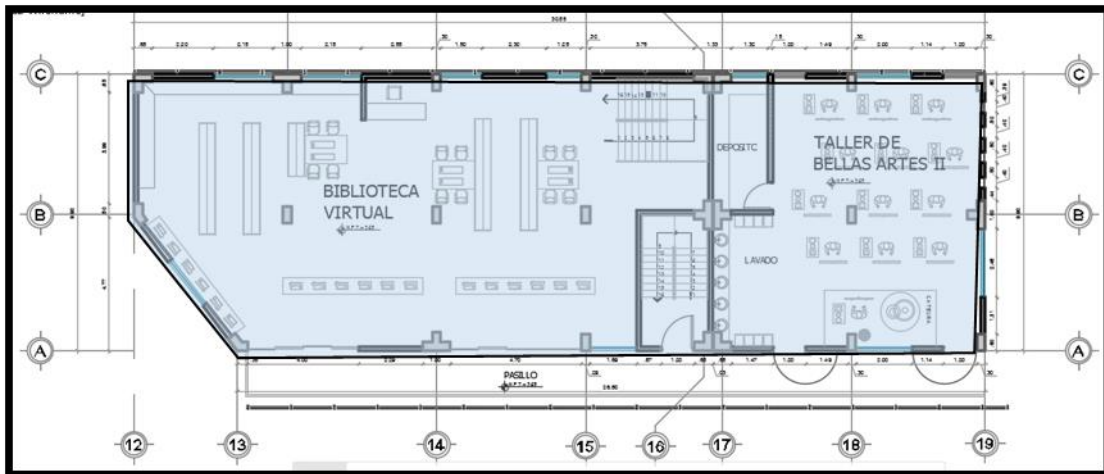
Planimetría de Biblioteca Virtual– Liceo
